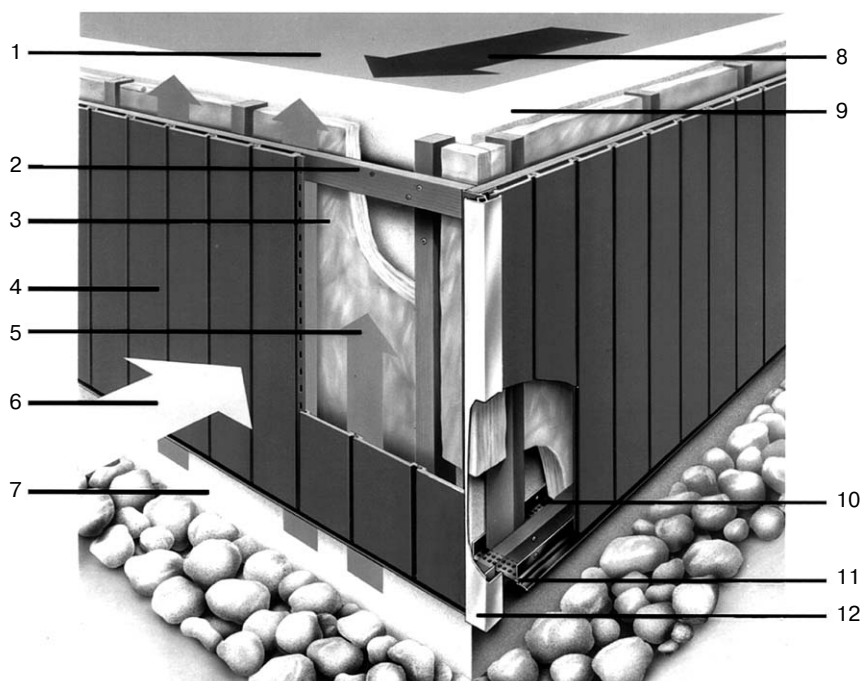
Система вентилируемого фасада: 1 – помещение, 2 – деревянная обрешетка, 3 – теплоизоляционный слой, 4 – фасадный профиль WERZALIT, 5 – зазор для вентиляции, 6 – возможные атмосферные воздействия, 7 – цоколь здания, 8 – водяные пары и тепло, 9 – конструкционный стеновой материал, 10 – вентиляционный профиль, 11 – вспомогательный профиль, 12 – угловой профиль
